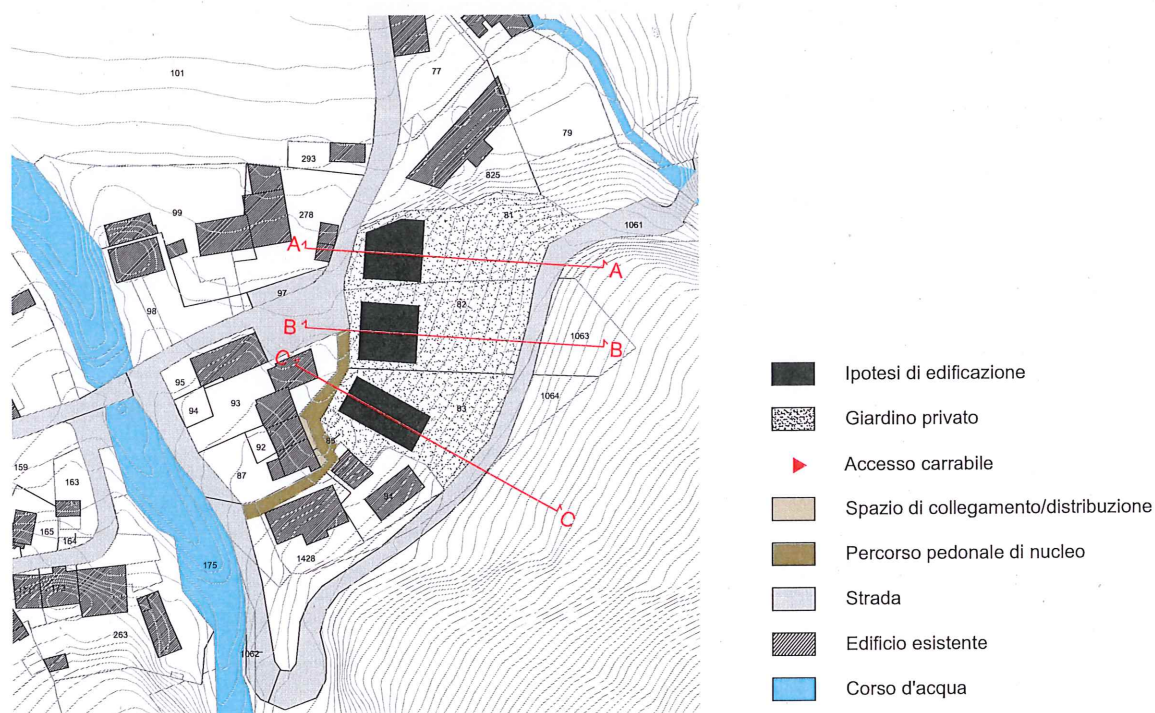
schema planimetrico della possibile edificazione per i fmn. 81, 82 e 83
